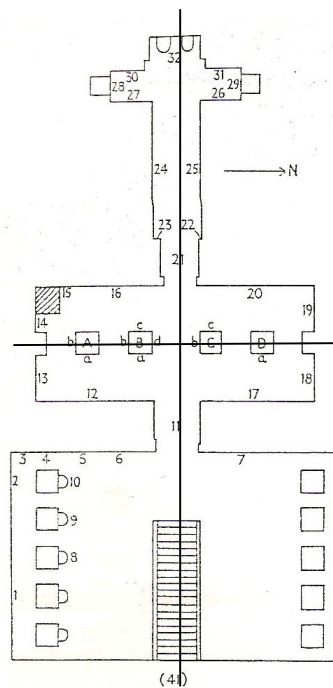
Dualidad y simetría arquitectónica en la planta de TT41 (PM I, 80).
